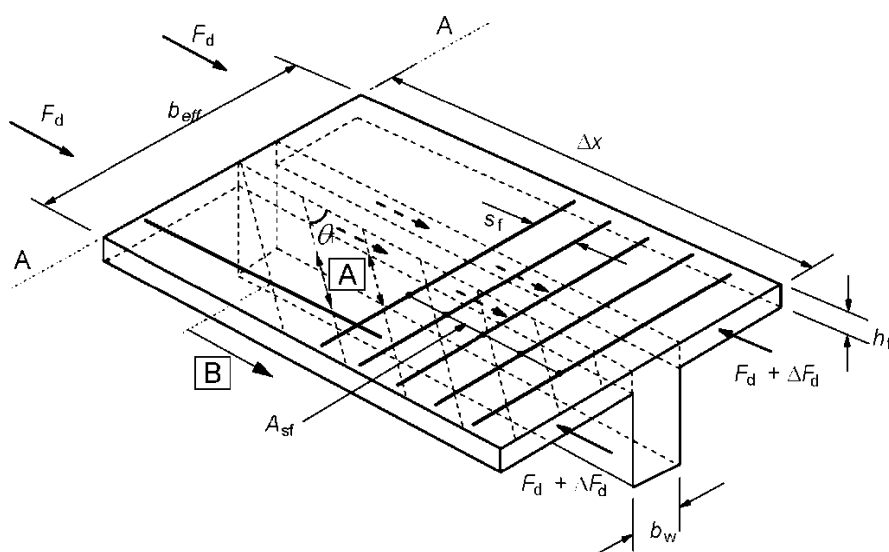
Расчетная модель соединения между бетонной плитой с ребром:
